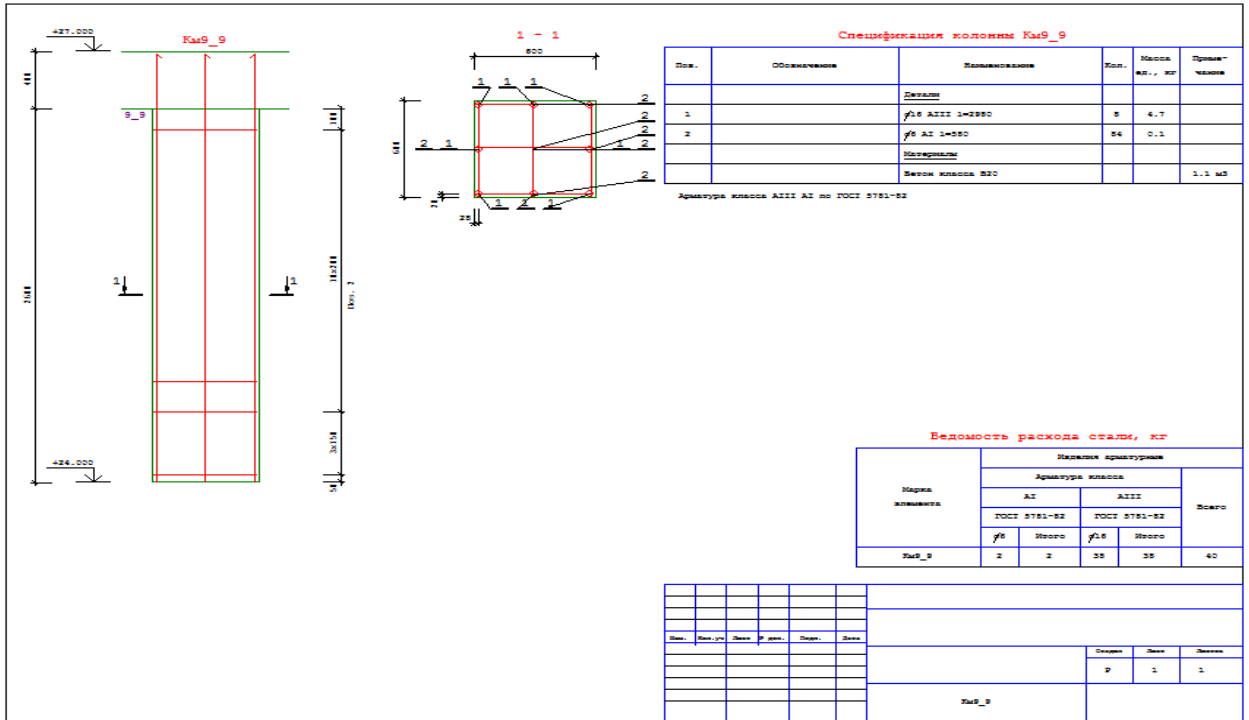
Варіант будинку з плитними перекриттями. Колонна К9-9. Креслення робочого проекту
